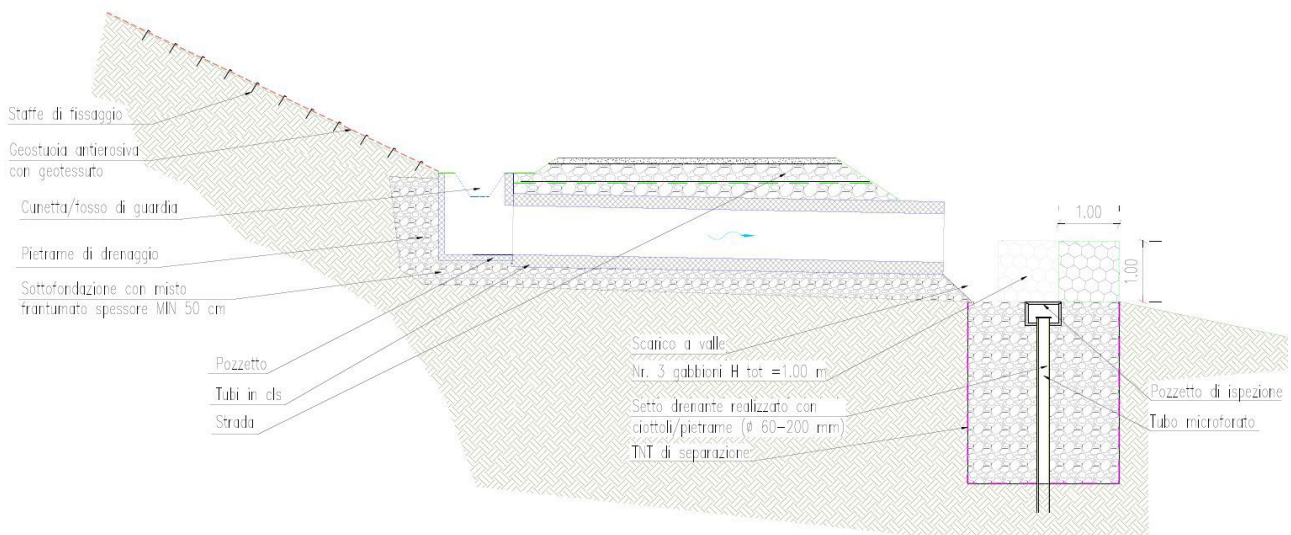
Opere di regimentazione idraulica – setto drenante
